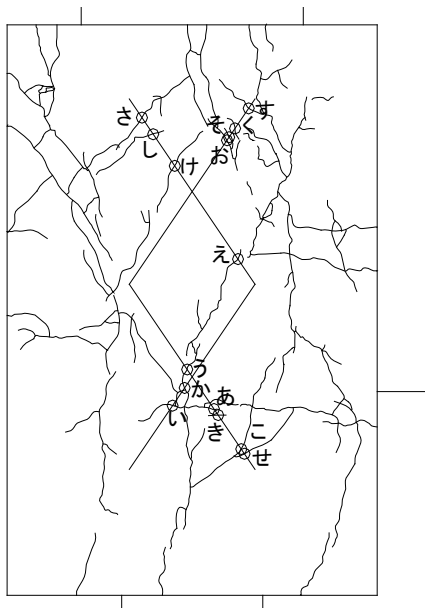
パイルキャップひび割れ幅測定位置 (試験体 A-5 正載荷)
